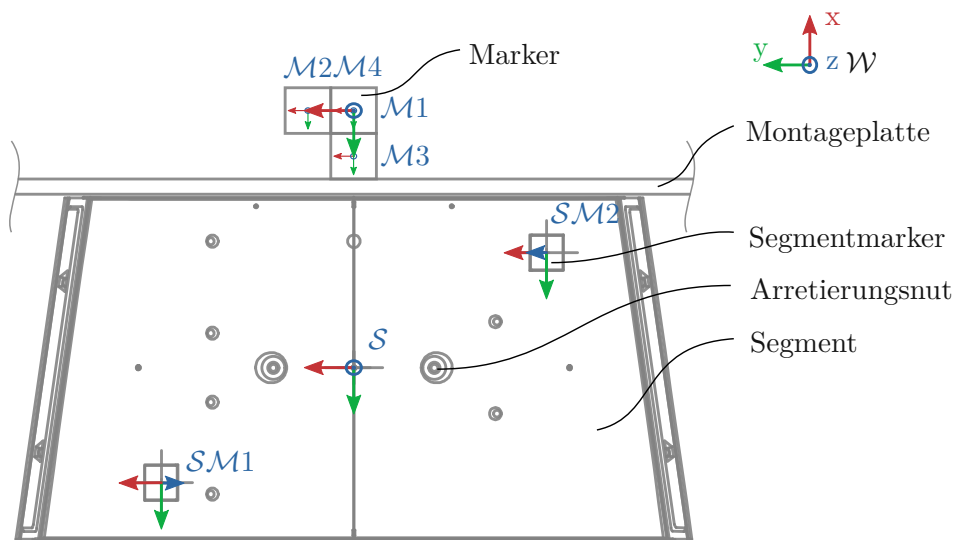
Grundriss des im Ring positionierten Segments K.
